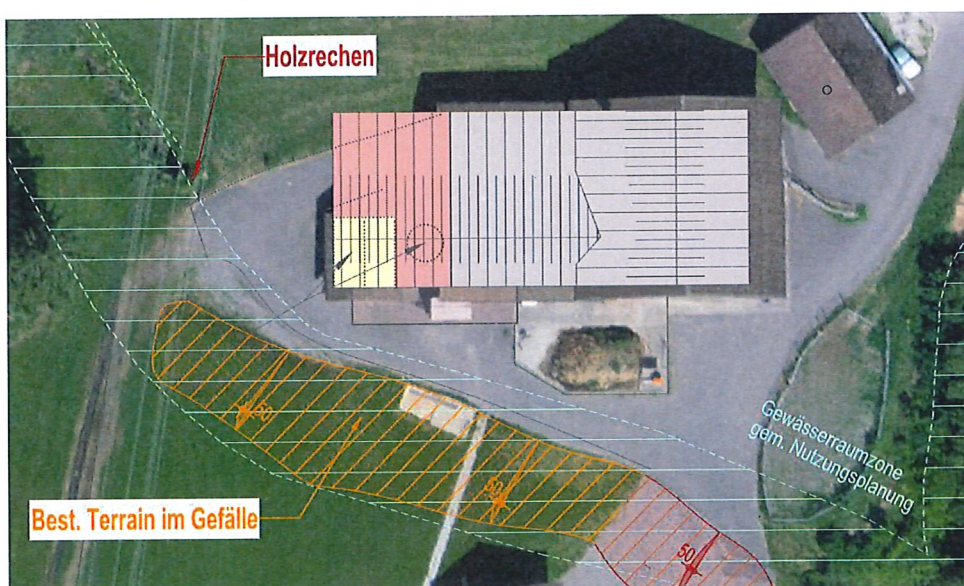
Situationsplan des projektierten Anbaus (rot) an den bestehenden Kuhstall (grau) [2]
